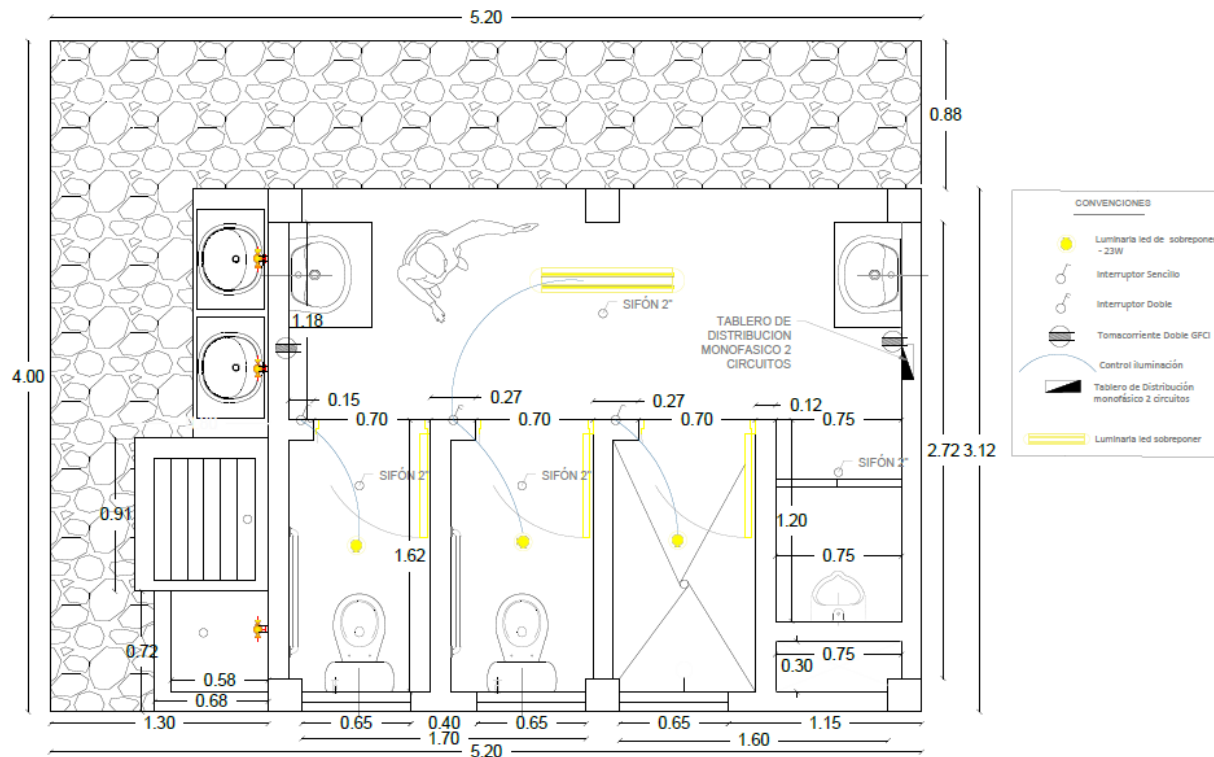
Plano vista en planta batería sanitaria Casa Cabildo
